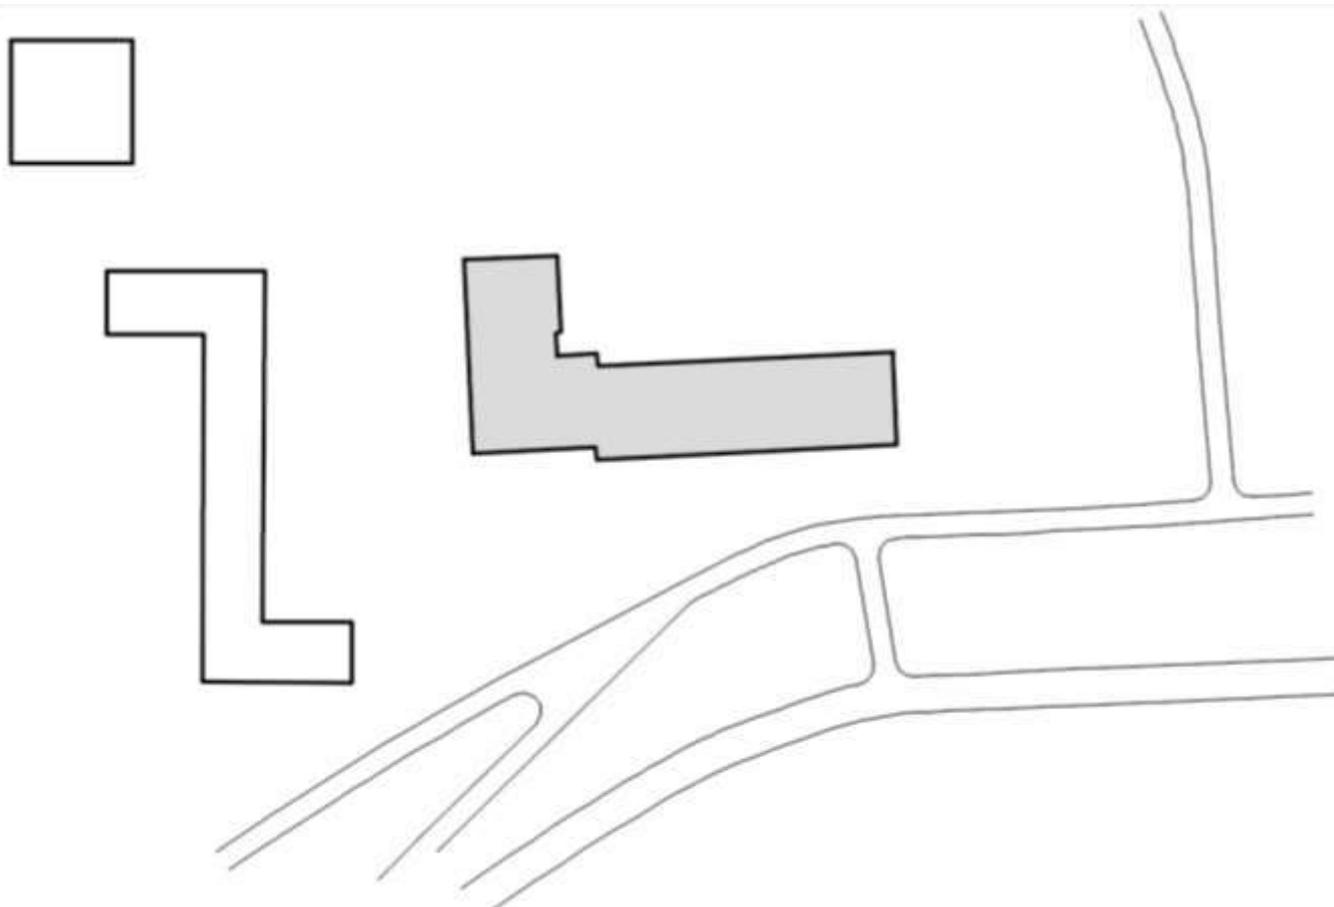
Житловий будинок з прилеглою забудовою
